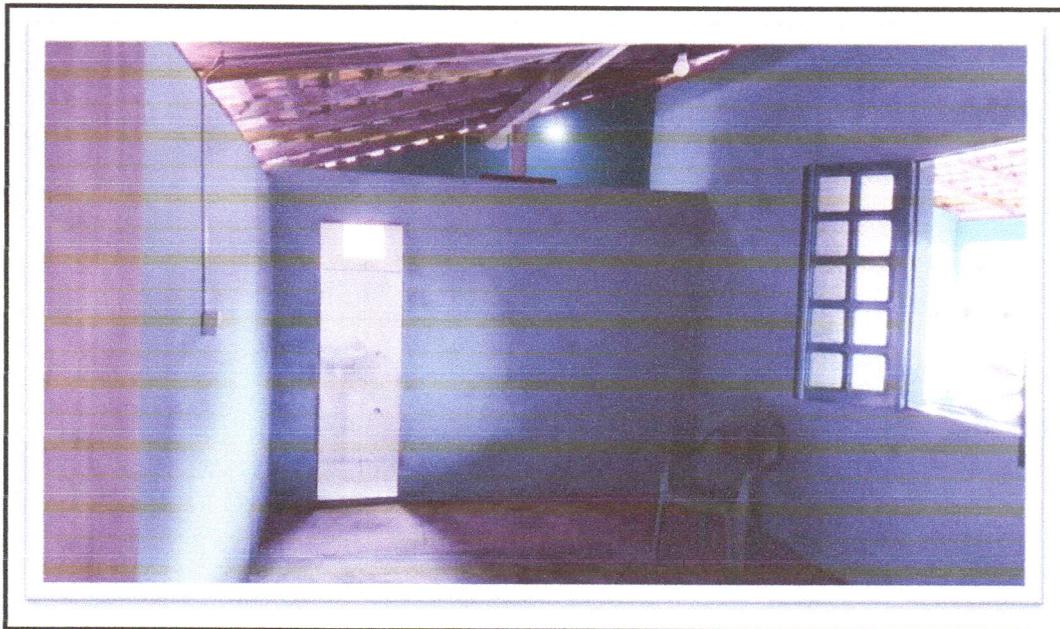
Suíte do bloco 02 com banheiro ao fundo.
